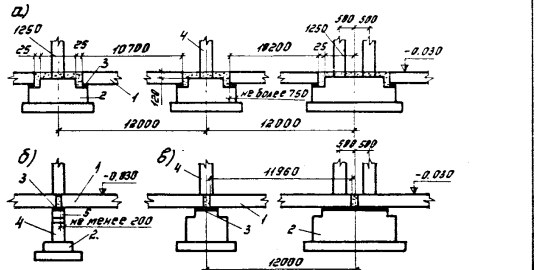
Опирание фундаментных балок при шаге колонн 12 м а-опирание балок на ступени фундаментов; б-то же, на консоли колонн; 1-фундаментная балка; 2-фундамент; 3-слой цементного раствора; 4-колонна; 5-консоль.
